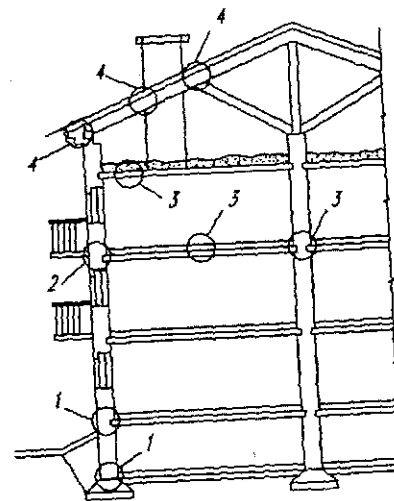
Наиболее уязвимые места в конструкциях: 1 — в фундаментах и стенах подвала; 2 — в стенах; 3 — в перекрытиях; 4 — в крыше
